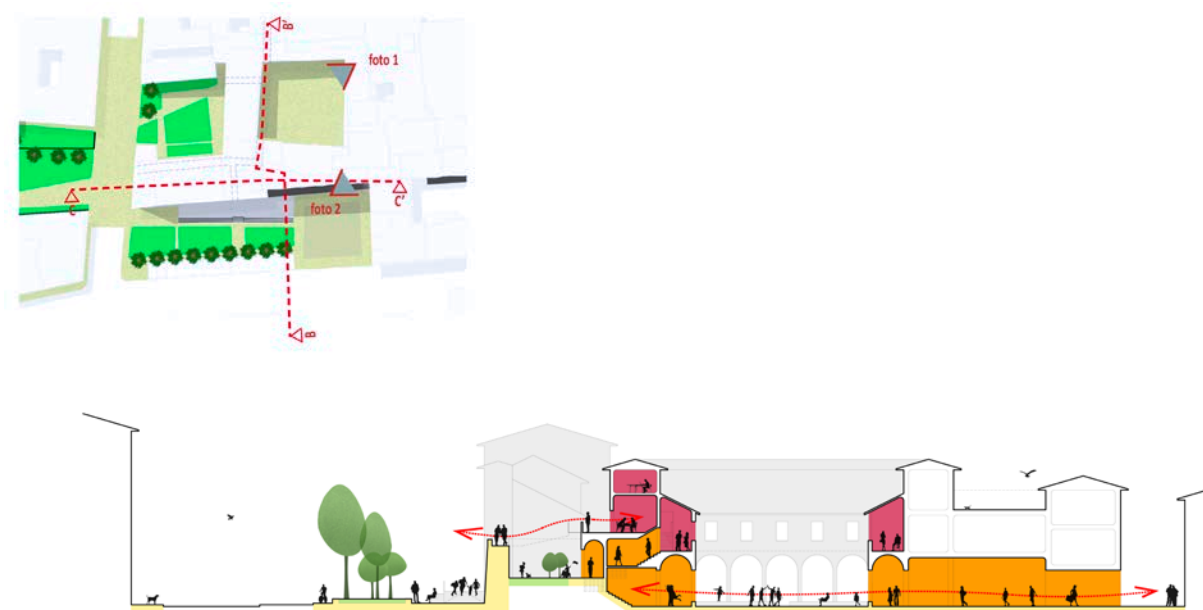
SEZIONE B-B' / STATO DI PROGETTO
